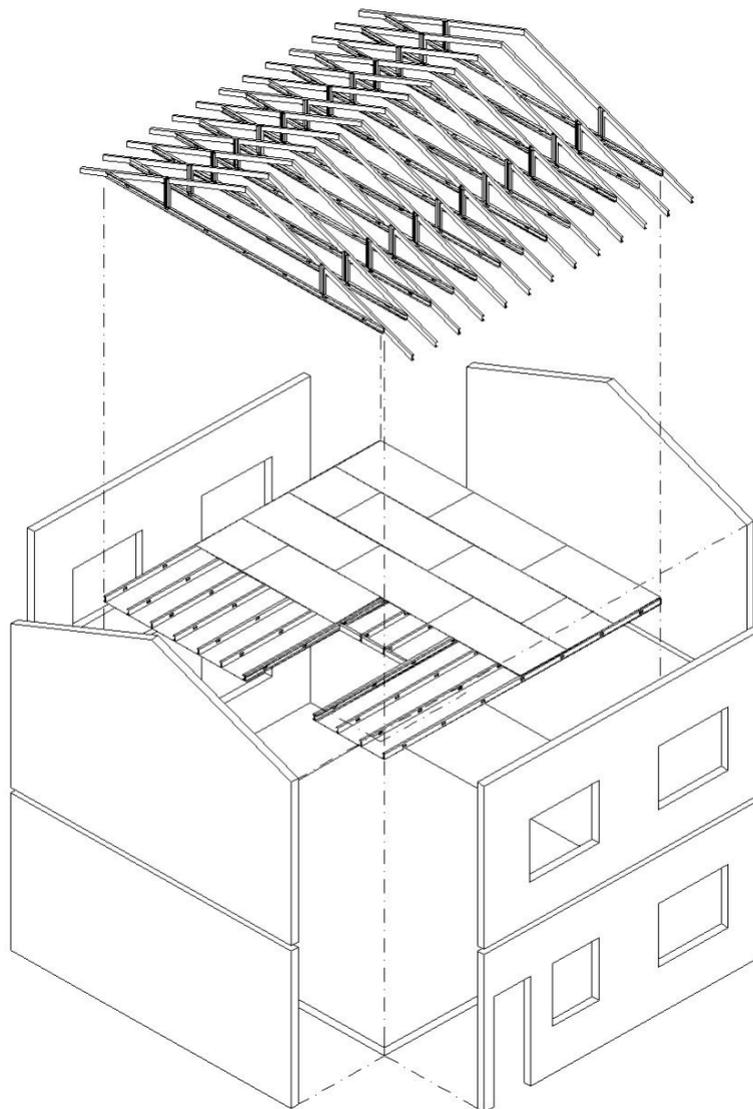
Esquema de construção tipo “platform” . Fonte: Grubb e Lawson, 1997.
